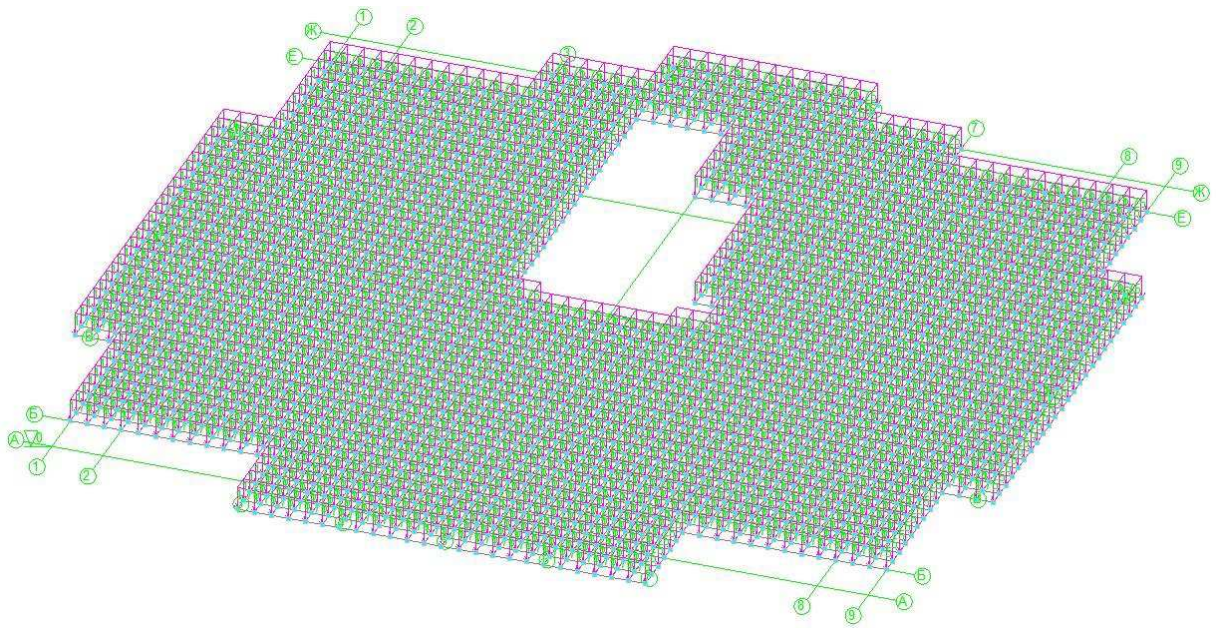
Схема загрузки плиты нагрузкой от веса пола
